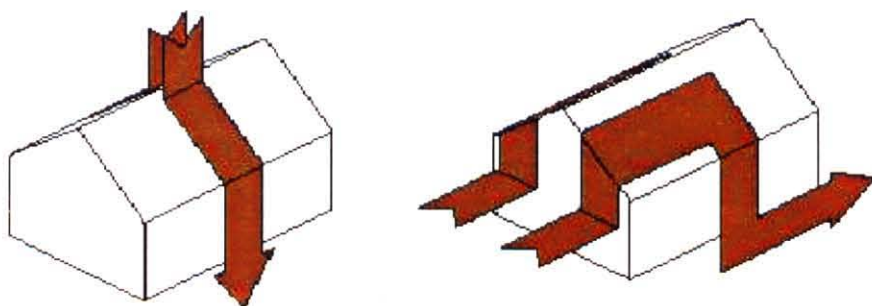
Tipos de carga sobre un panel estructural. Figura izquierda cargas verticales, figura derecha cargas horizontales.
